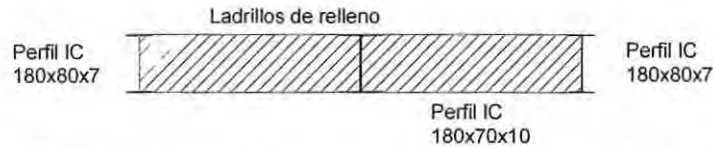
Corte 3-3 planos de elevación Figura 1.12, configuración del 3° y 4° piso.
